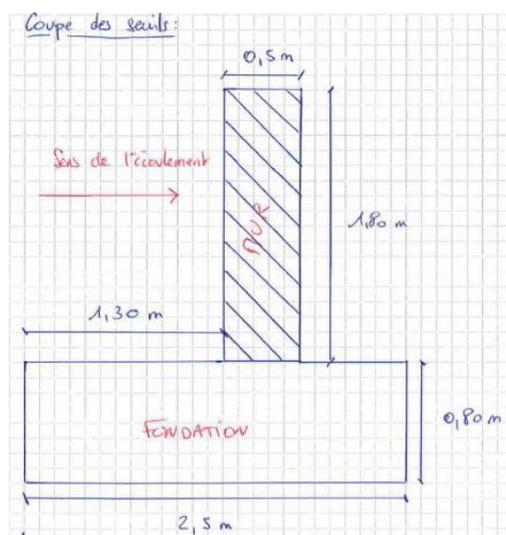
coupe des seuils issus du rapport de chantier des sondages géotechniques - janvier 2022
